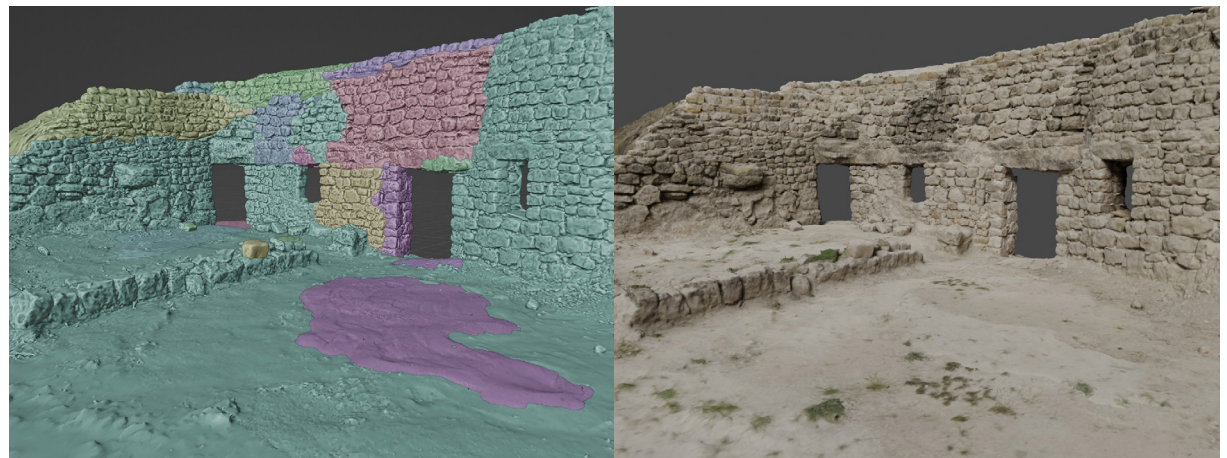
Estado de la fachada de la casa cueva tras la reconstrucción. Visualización en matcap y renderizado Fuente: *Elaboración propia
